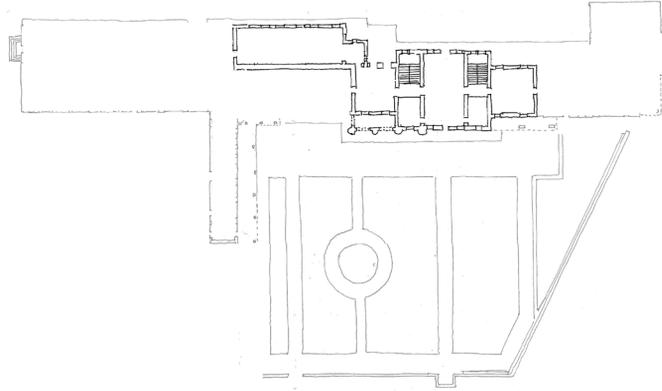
identificazione, rispetto alla situazione odierna, della possibile pianta piano terra più antico (1600) di Villa Angaran alle Carubine, Antoranz, 2017.
